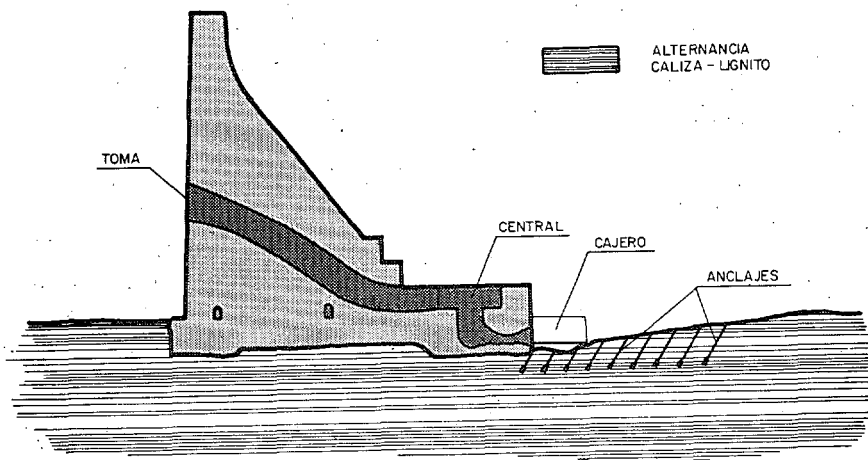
Presa de Mequinenza. Refuerzo de anclajes.
